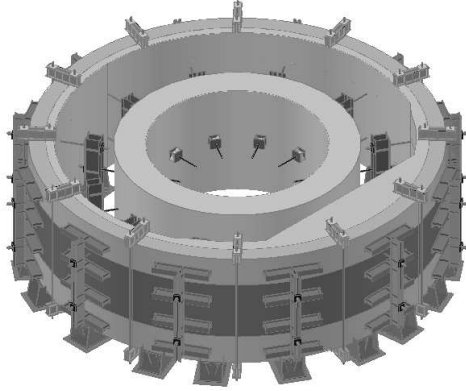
Anillo de dovelas, cubeta y revestimiento secundario con estructuras de aplicación de carga.
